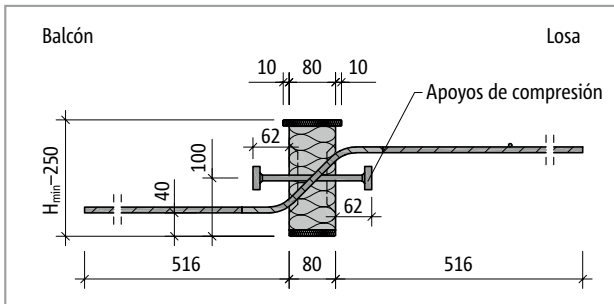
Schöck Isokorb® T tipo Q-P-V5: Sección del producto
